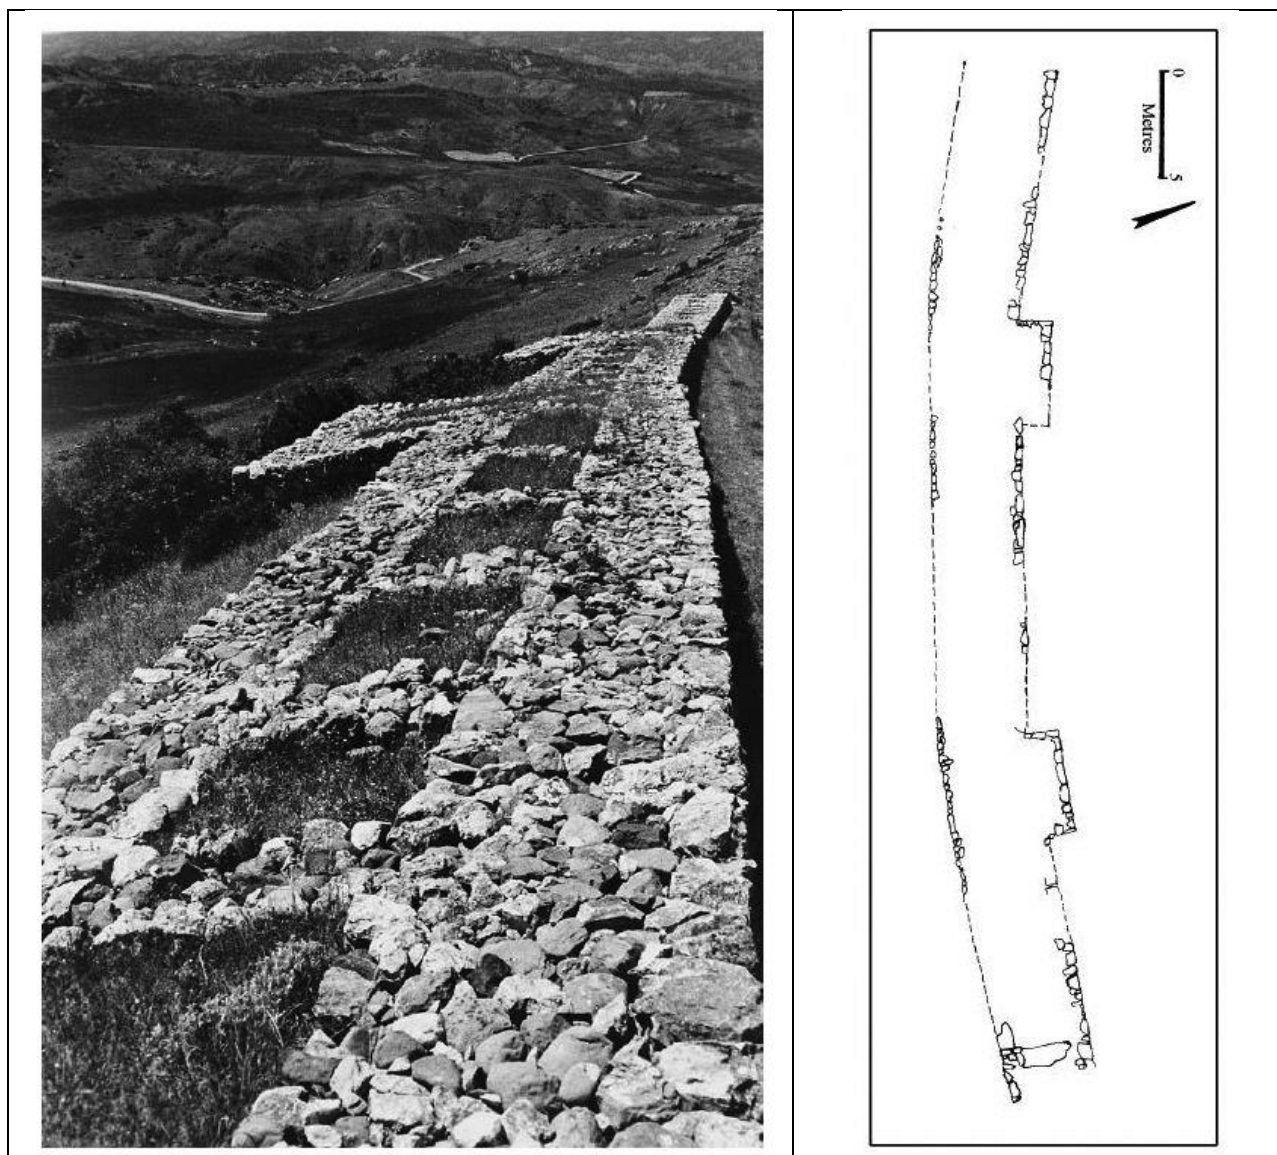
Натурное фото и план фрагмента оборонительной стены в южной части Милета.
